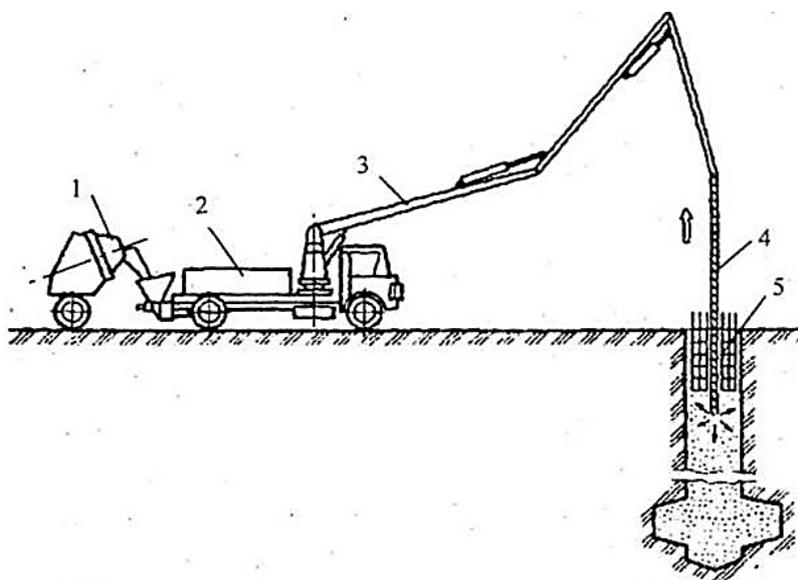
Бетонирование конструкций методом напорного бетонирования:
